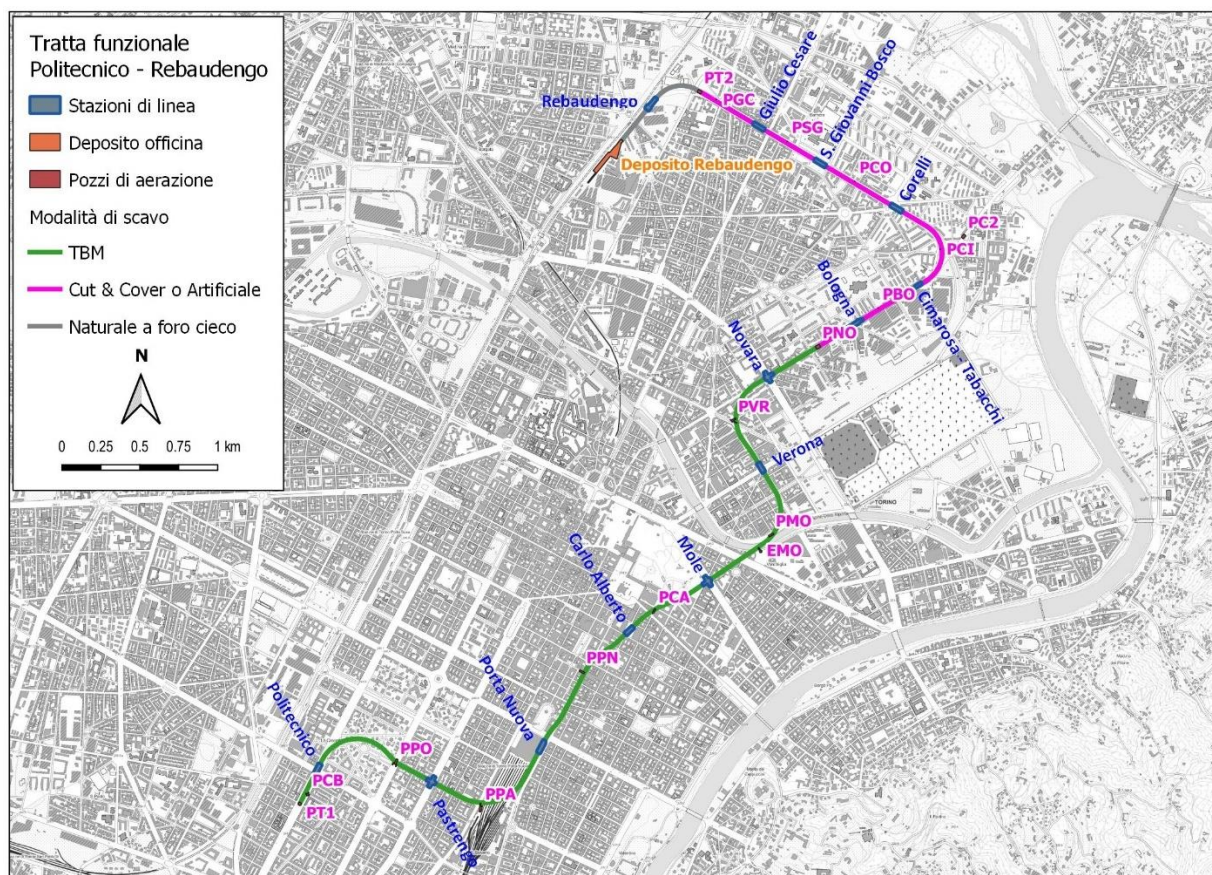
Suddivisione della ML2 in base alle modalità di scavo previste.
